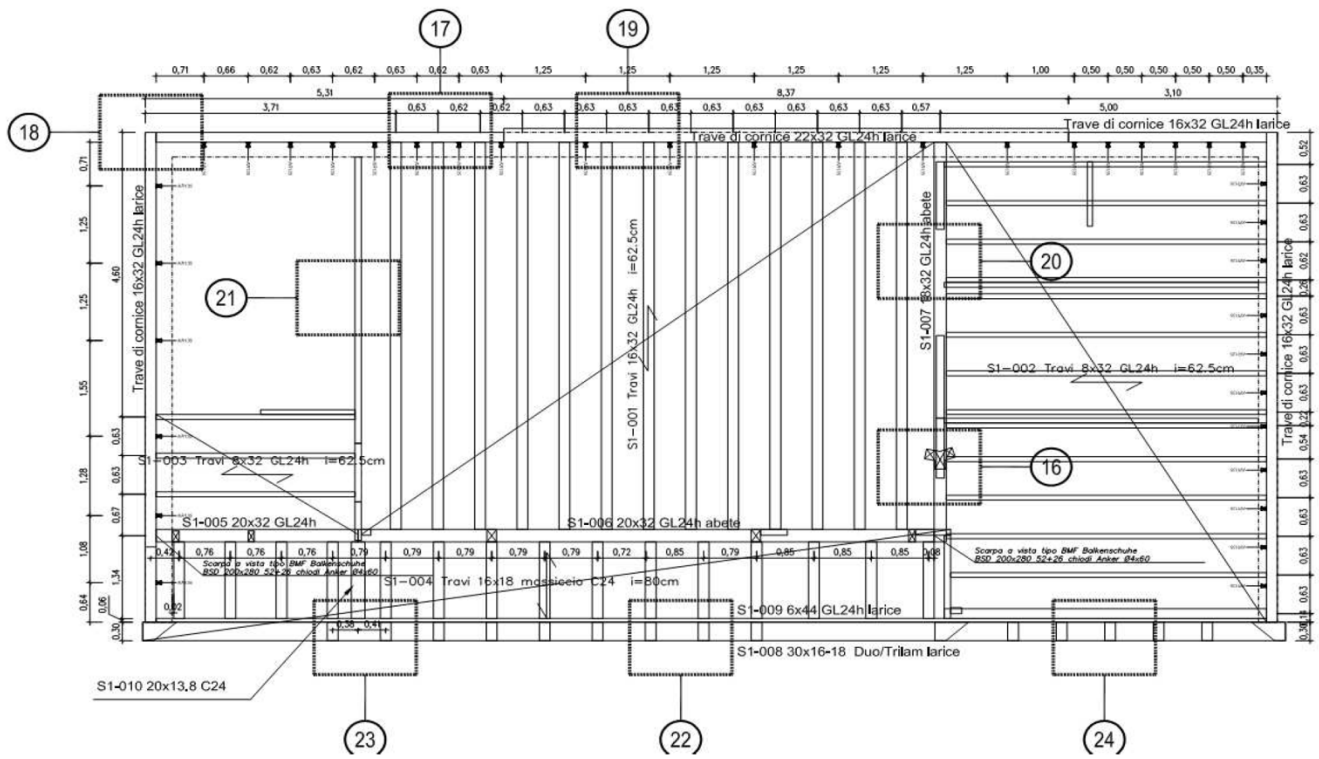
Pianta carpenterie solaio tipo (progetto fornito dal progettista arch. Mirko Franzoso)
